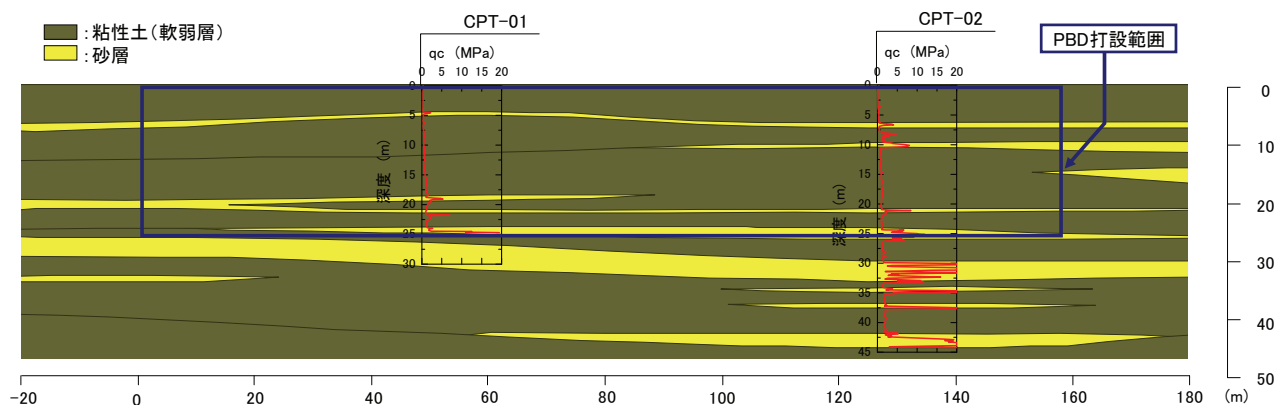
PBD 施工範囲の地質想定縦断面図と事前調査位置
